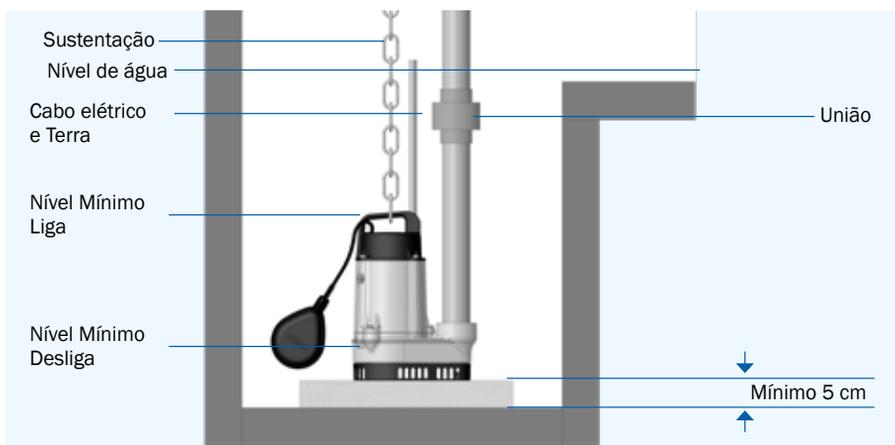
Esquema de instalação da motobomba Série Brava com boia elétrica integrada.
